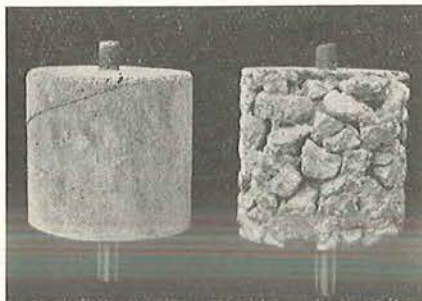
To prøvecylindre af samme betoning, til venstre vibreret, til højre haandstampt.
